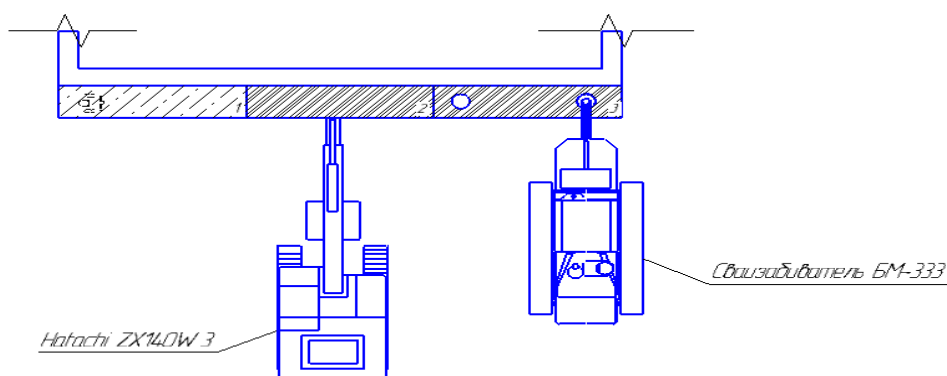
Демонтаж асфальтобетонного покрытия с последующими работами:
